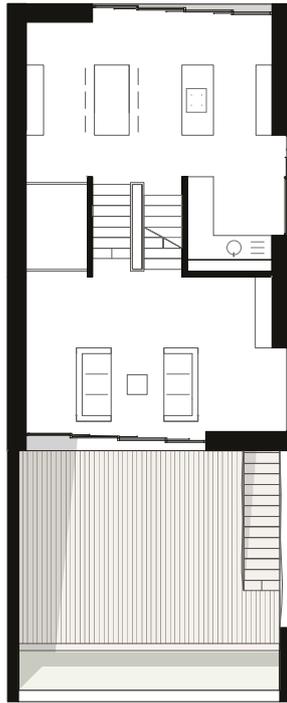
Grundriss OGs Typ 2: Zone II. M 1:200
